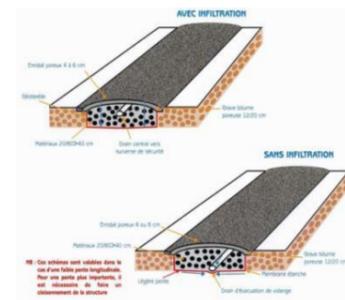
Figure. I. : Les chaussées réservoir. (Source : Charte-de-lecocitoven).
